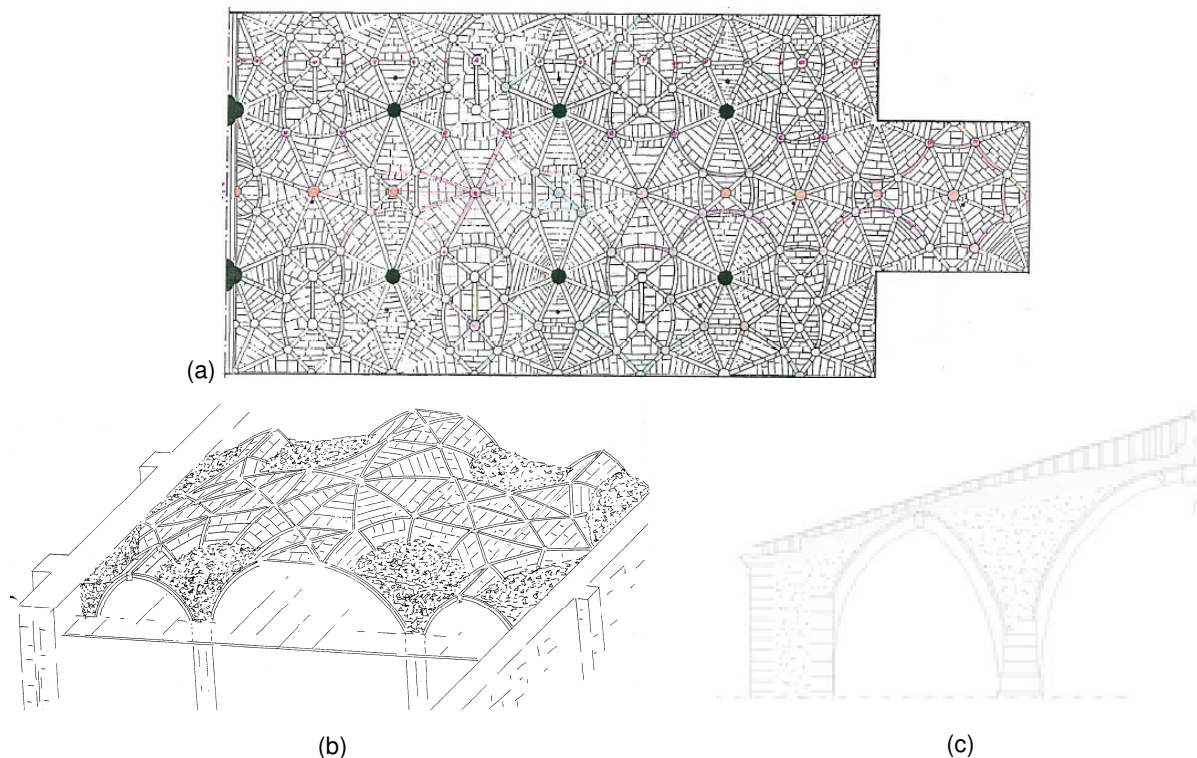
Constituição da abóbada da nave: (a) lajetas de pedra entre nervuras; (b) enchimento dos capitéis, (c) corte transversal com indicação esquemática do recobrimento da abóbada (Genin, 1995).
